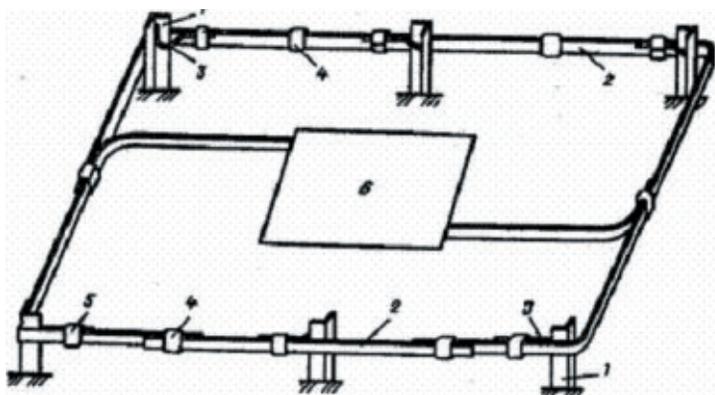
Общий вид заземляющего контура, выполненного методом термической сварки. 1 — вертикальный заземлитель; 2 — горизонтальный заземлитель; 3 — связь заземлителя с горизонтальным заземлителем; 4 и 5 — усиление в месте сварки; 6 — заземляемый объект
